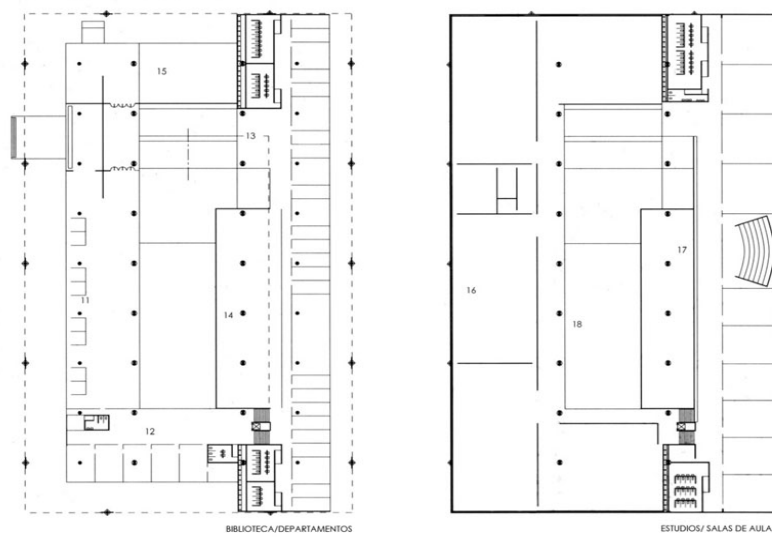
Planta Baixa da FAU-USP. Fonte: Plataforma Arquitectura.
